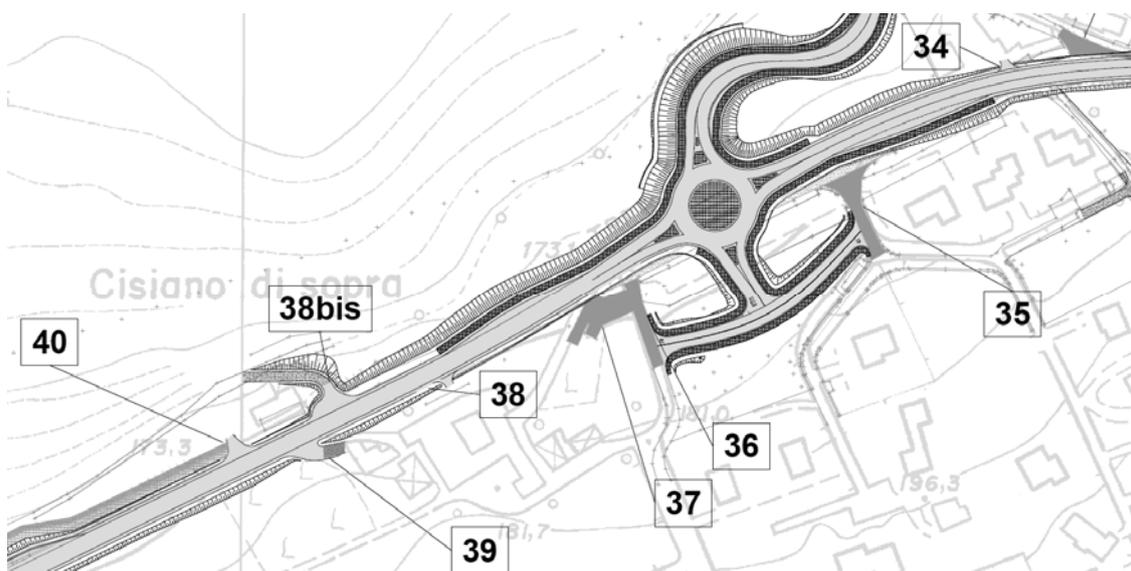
UBICAZIONE PLANIMETRICA DEGLI ACCESSI 38-39 E 38BIS-40.
